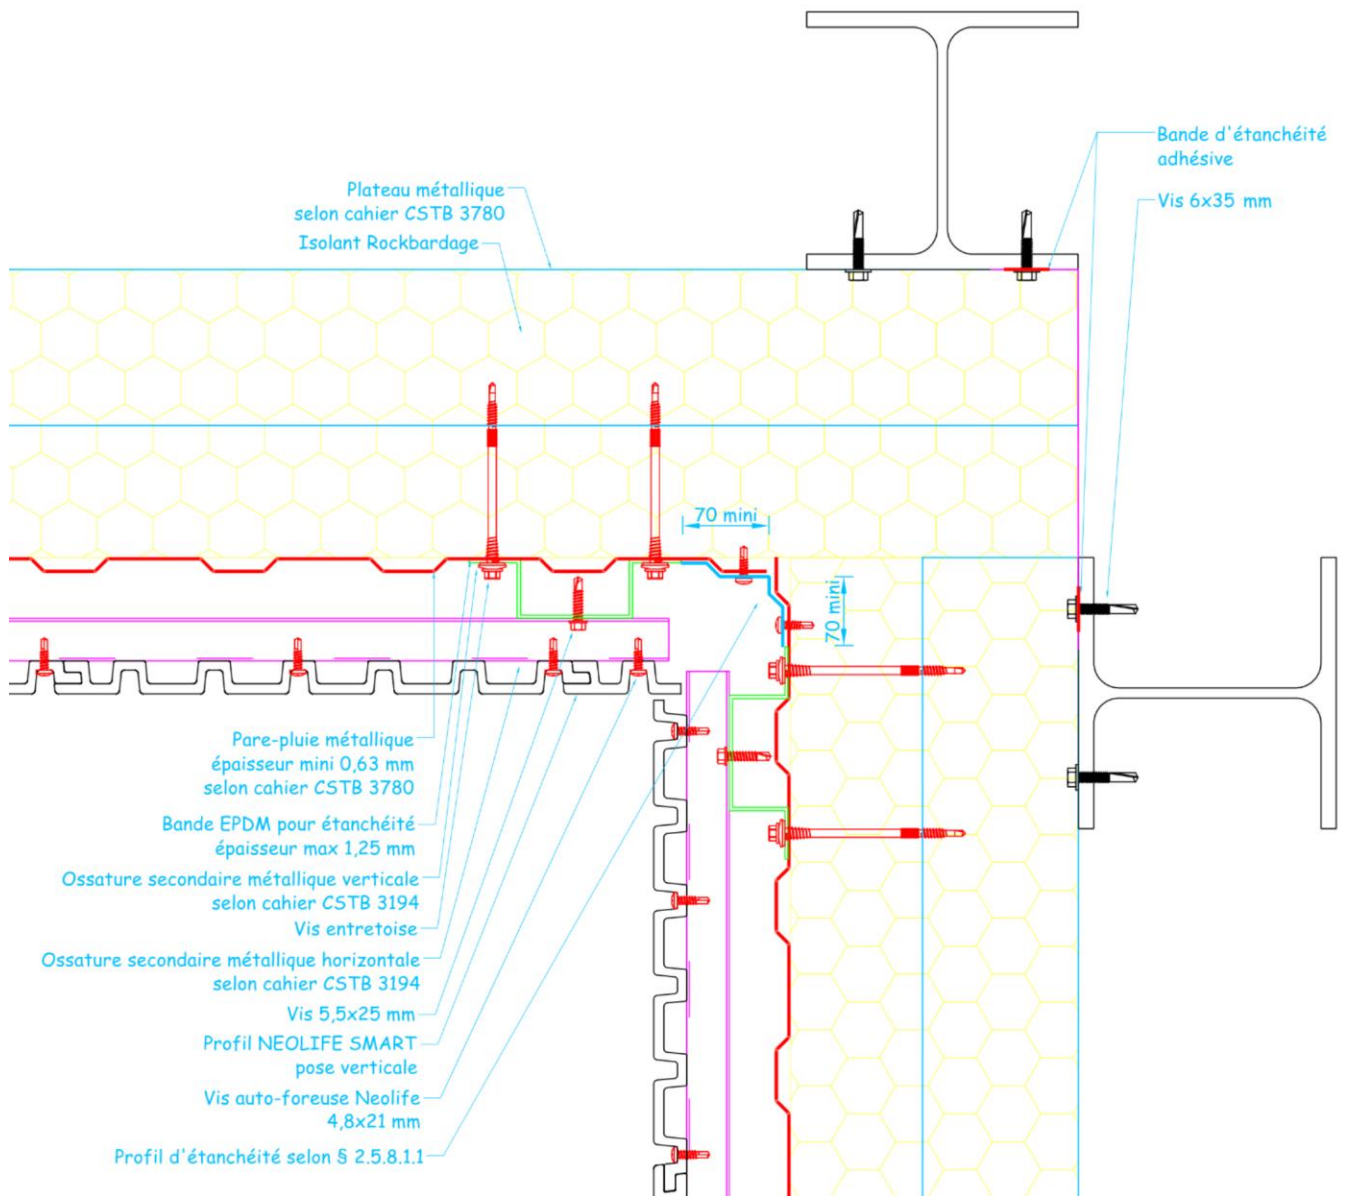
Arrêt sur acrotère (coupe verticale 3) – Pose horizontale
